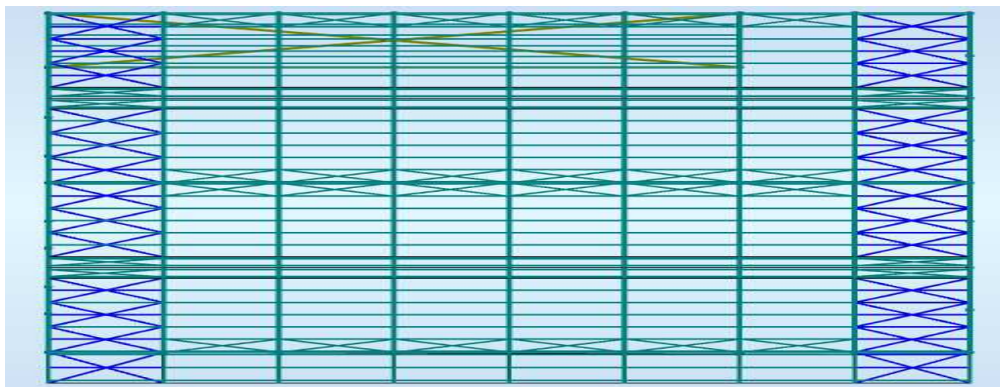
5: Vue en plan illustrant l'emplacement de la poutre au vent
